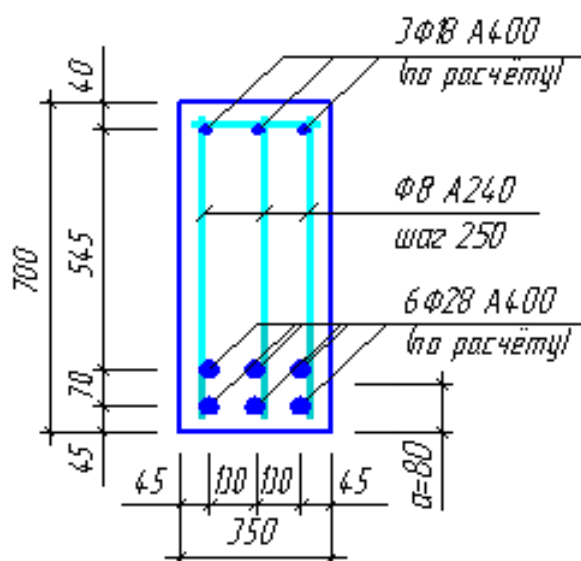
Армирование балки прямоугольного сечения двойной арматурой (пример)
